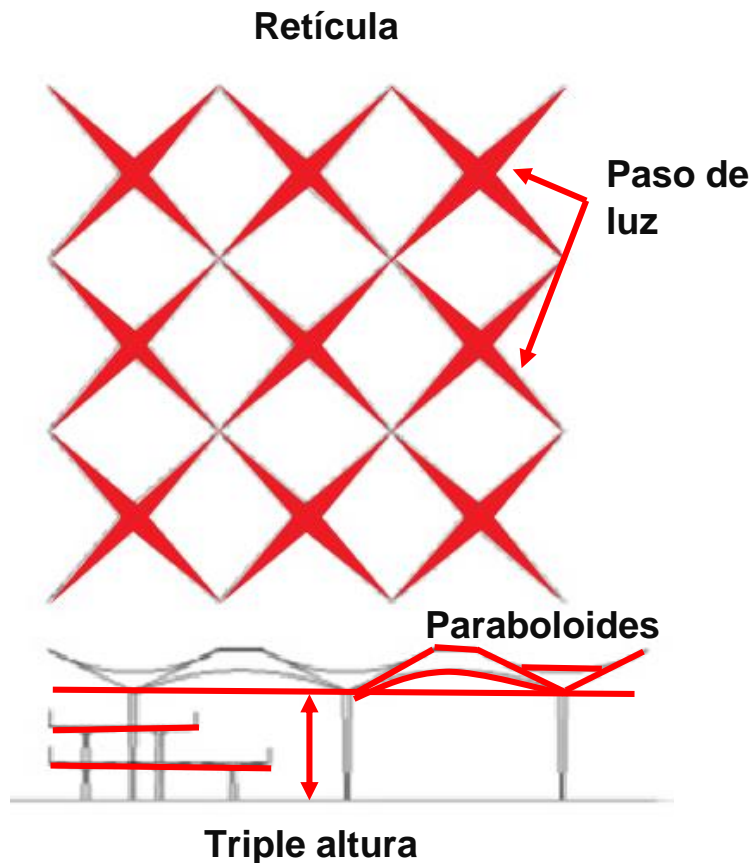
Retícula, Mercado Libertad, Guadalajara, México
